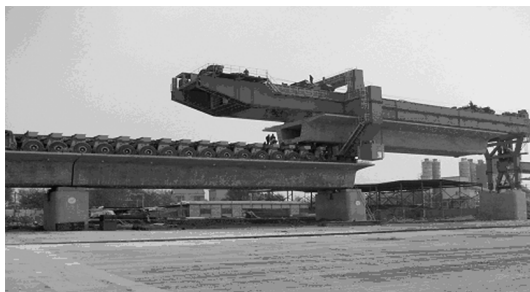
预制 32 m 混凝土筒支箱形梁架设实景图
